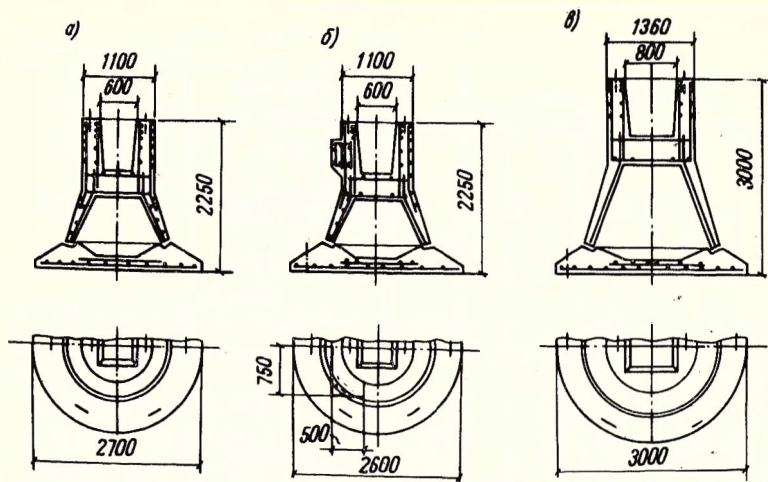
Конструктивное решение сборных фундаментов-оболочек а, в - бесконсольные варианты для фундаментов разной высоты; б- консольный вариант
